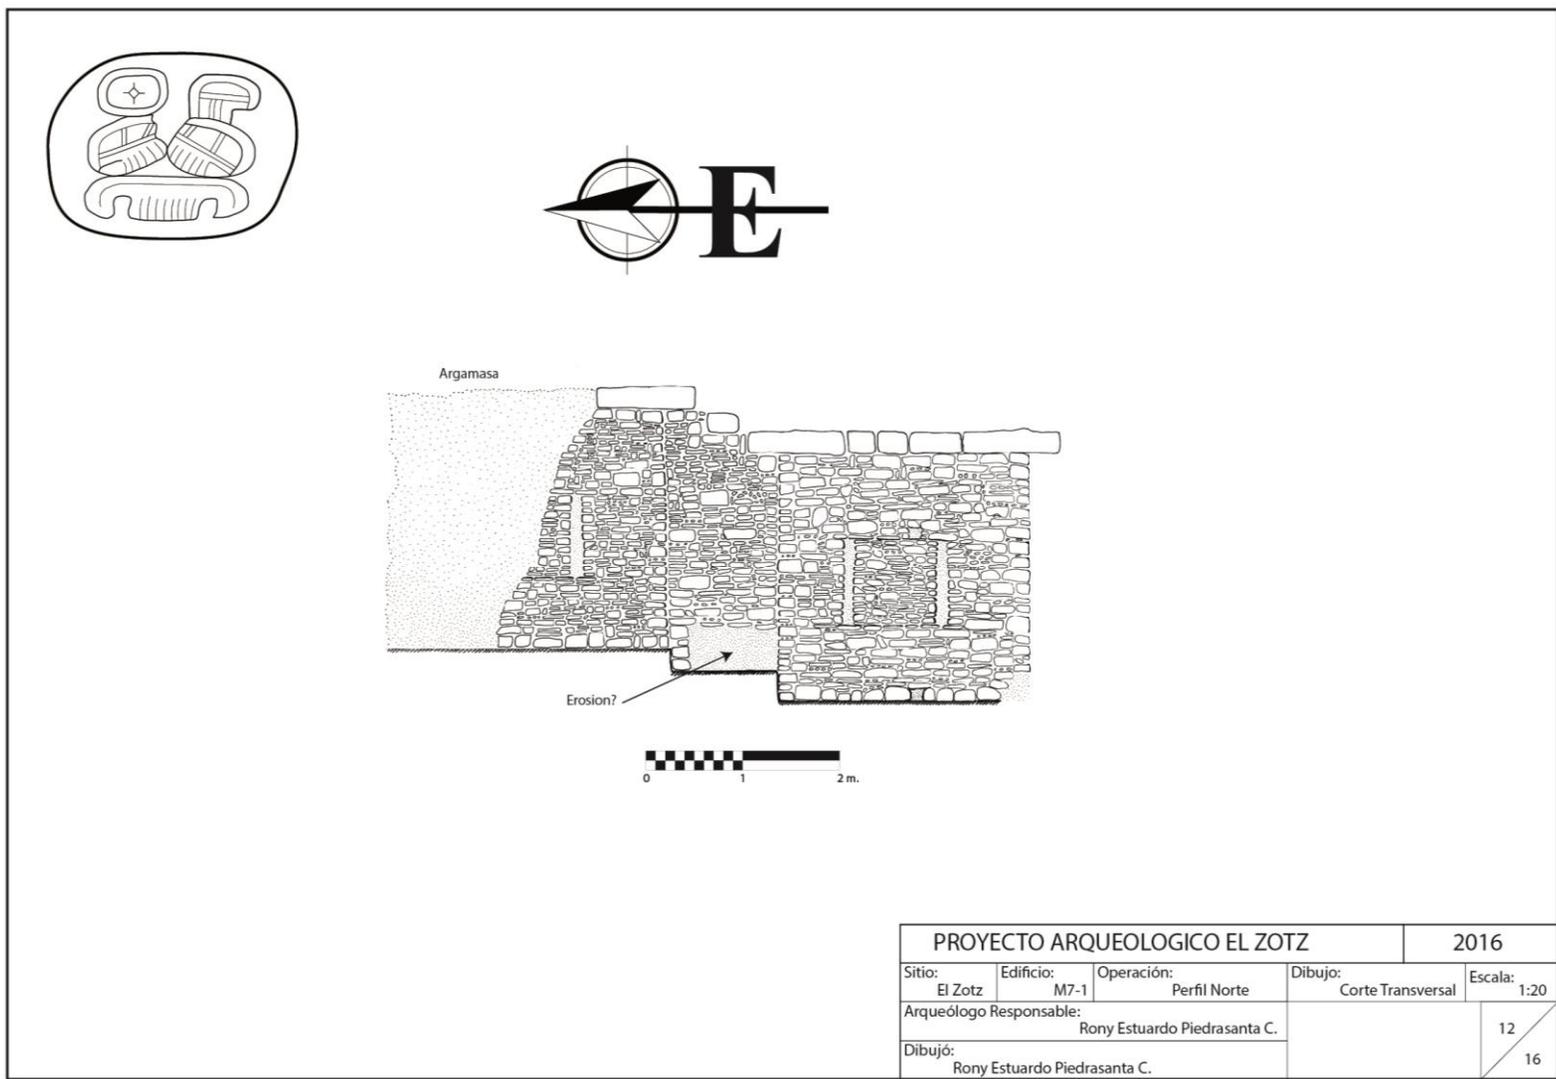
Muro Norte del Templo de la Estructura M7-1.
